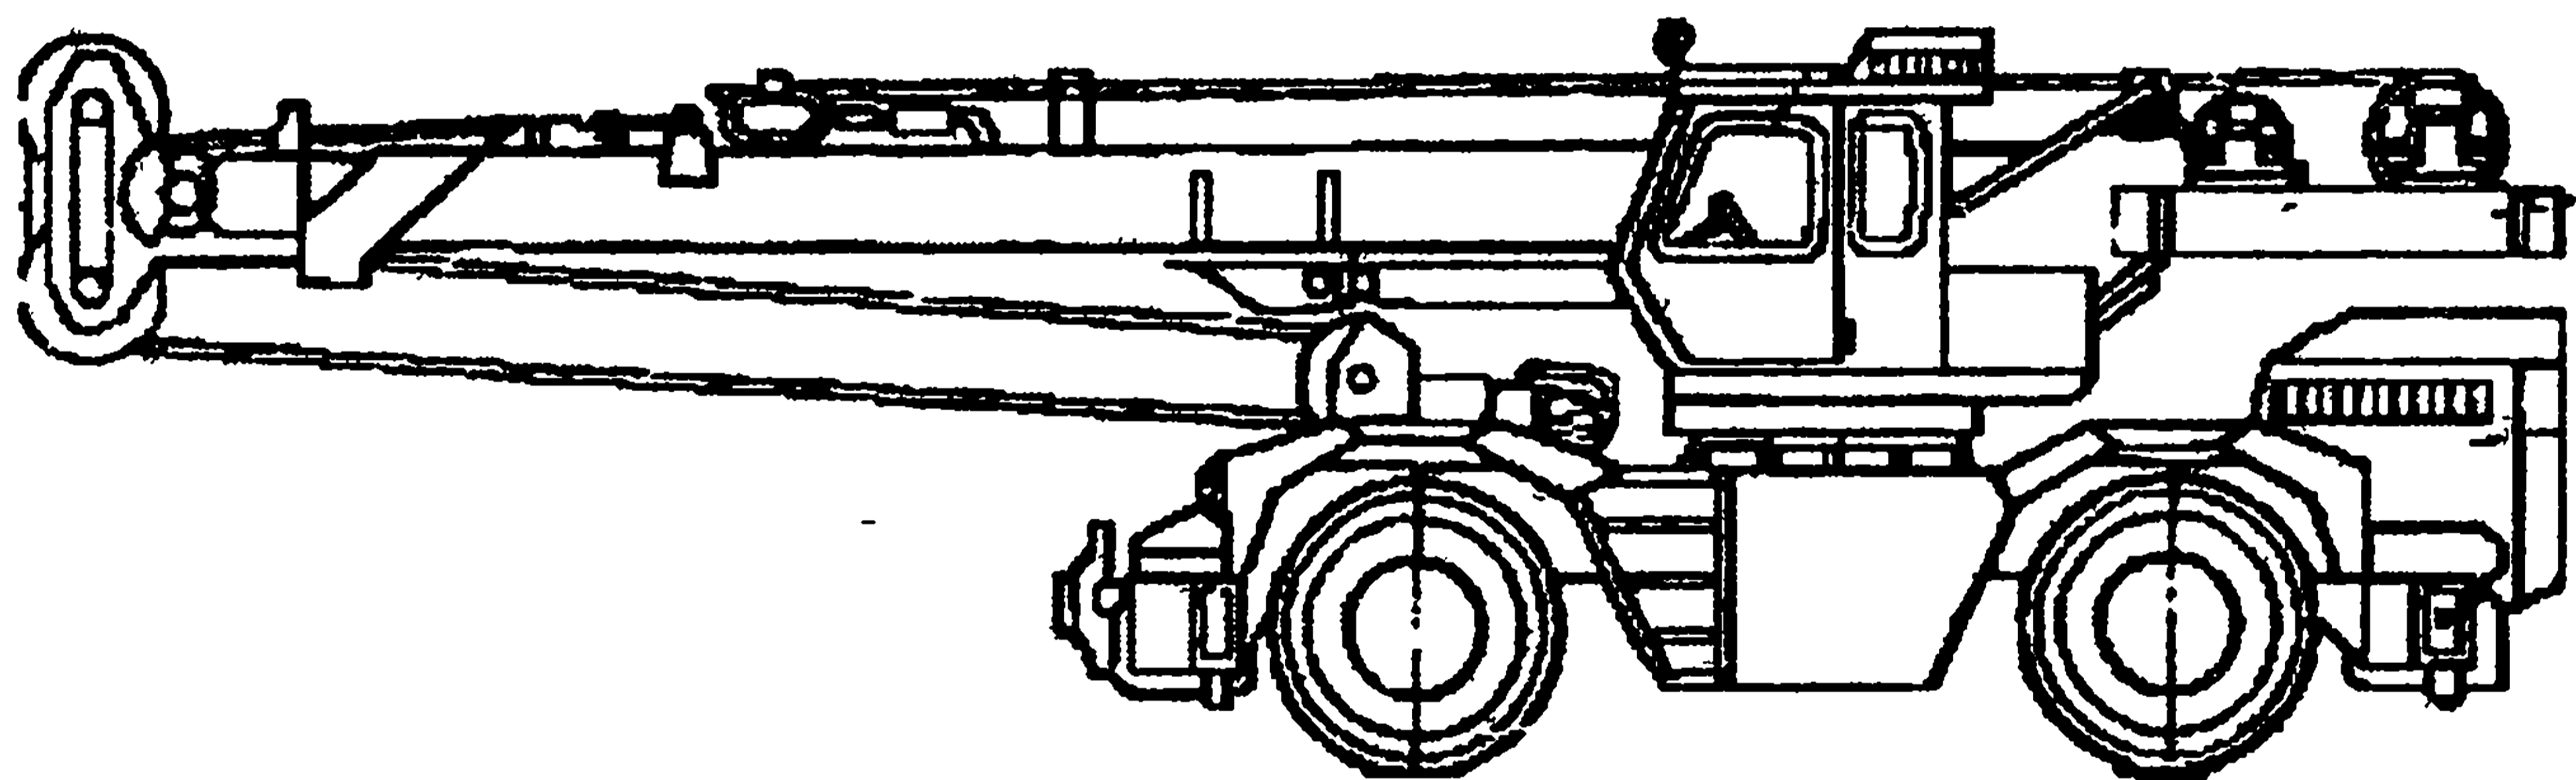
Короткобазовый пневмоколесный кран КС-4371
